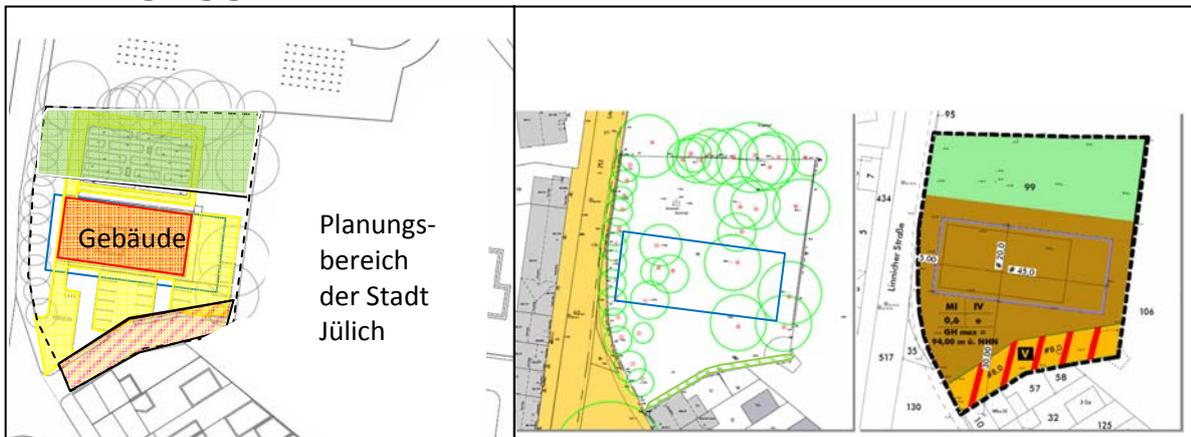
links: Planentwurf des Architekten (ergänzt); rot gekennzeichnet: Gebäude; rote Fläche; geplantes Verwaltungsgebäude, gelbe Flächen: Verkehrsflächen, blau: Baufenster; Mitte und rechts: Mitte: Bestandsplan der Bäume (grüne Kreise: Kronendurchmesser) (ASP); rechts: B-Plan Festsetzungen (Stadt Jülich): rot- schraffiert: Verkehrsfläche, braun: Fläche, in der Versiegelung zulässig ist, grün: Grünbereich
